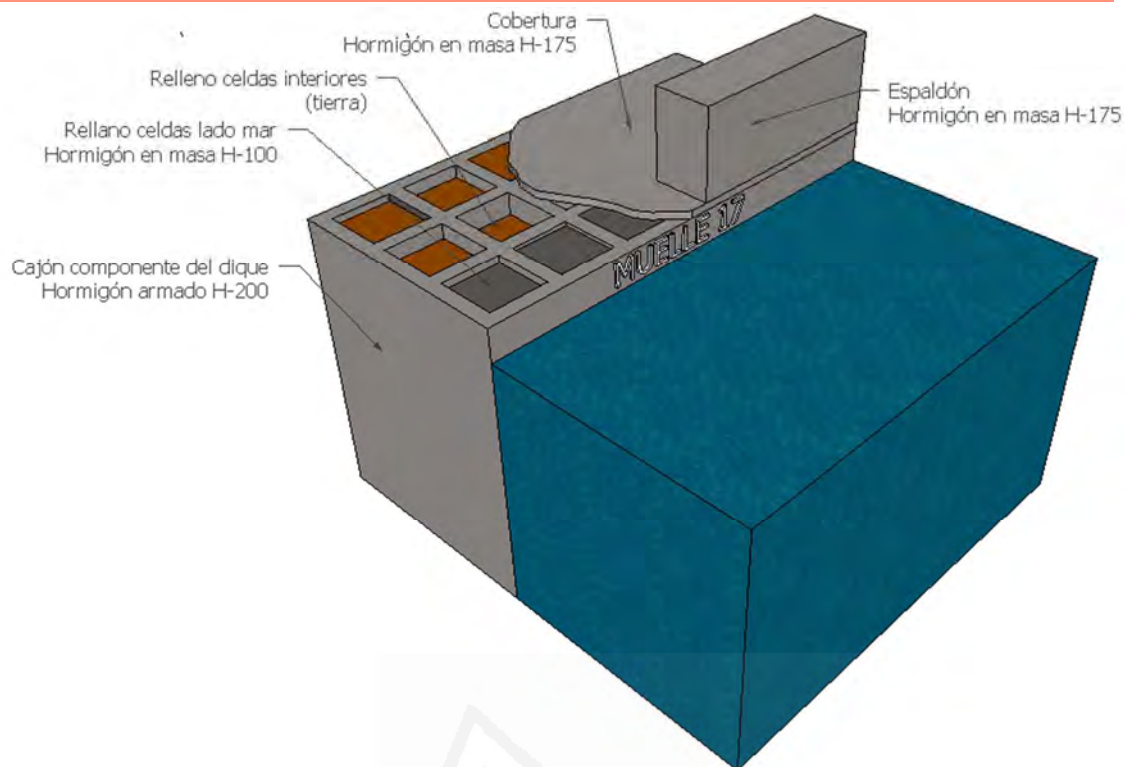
4: Esquema del cajón de hormigón que compone el muelle 17.
